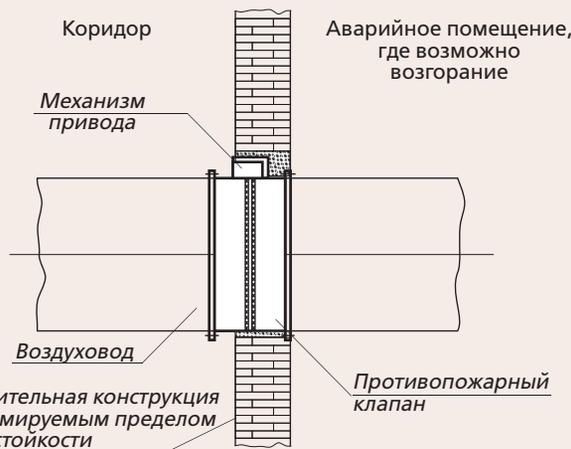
Установка противопожарного нормально открытого клапана в проеме ограждающей строительной конструкции
